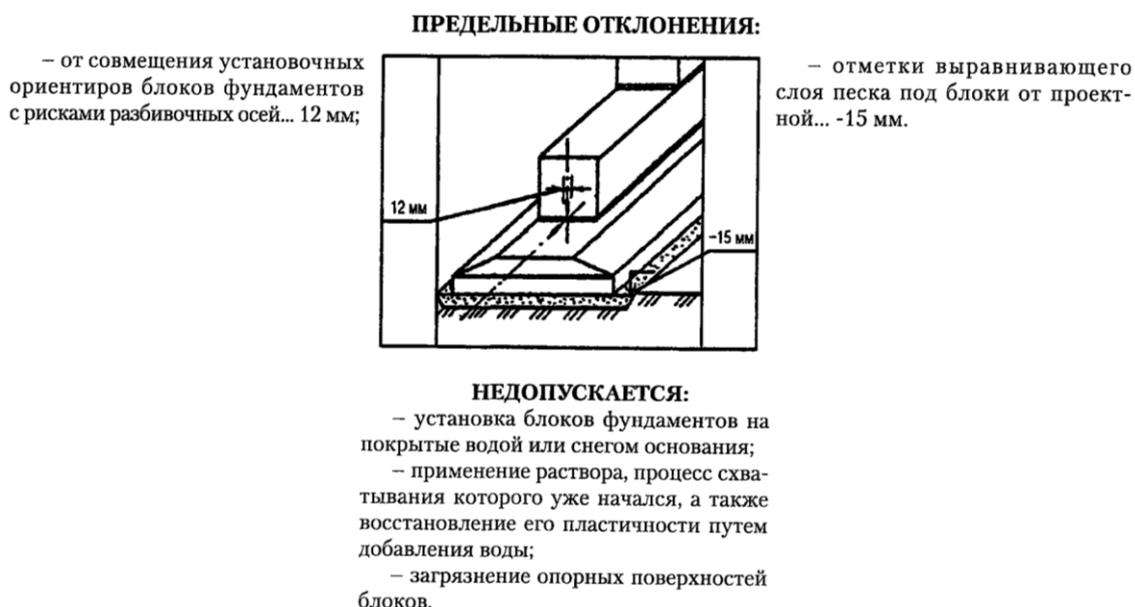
Допускаемые отклонения при монтаже сборных ленточных фундаментов
